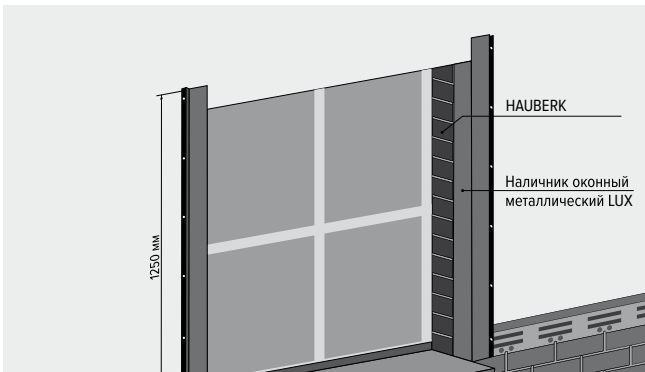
Монтаж фасадной плитки вокруг оконных проемов
